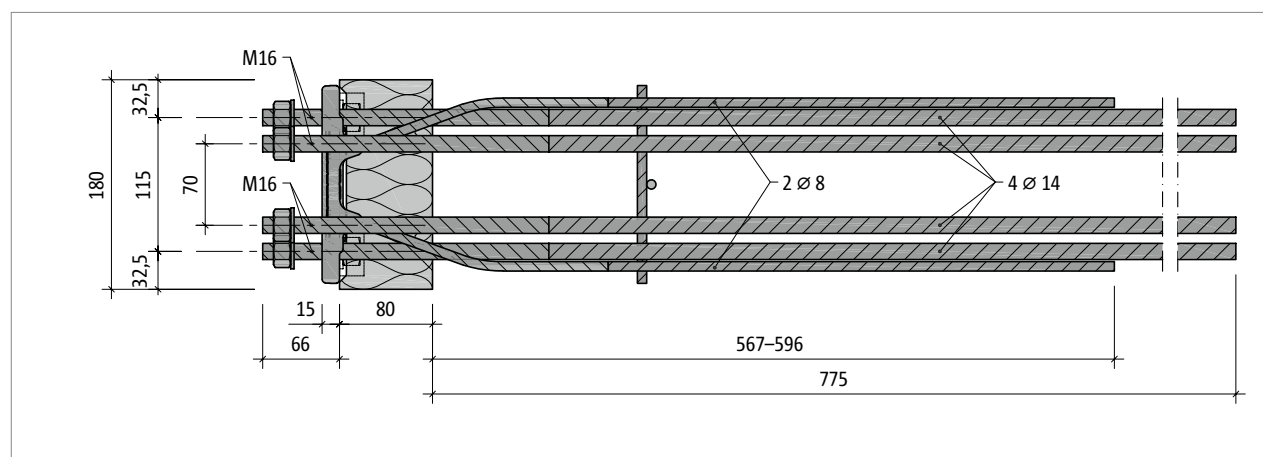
Schöck Isokorb® T type SK-MM1-VV1 : vue en plan
